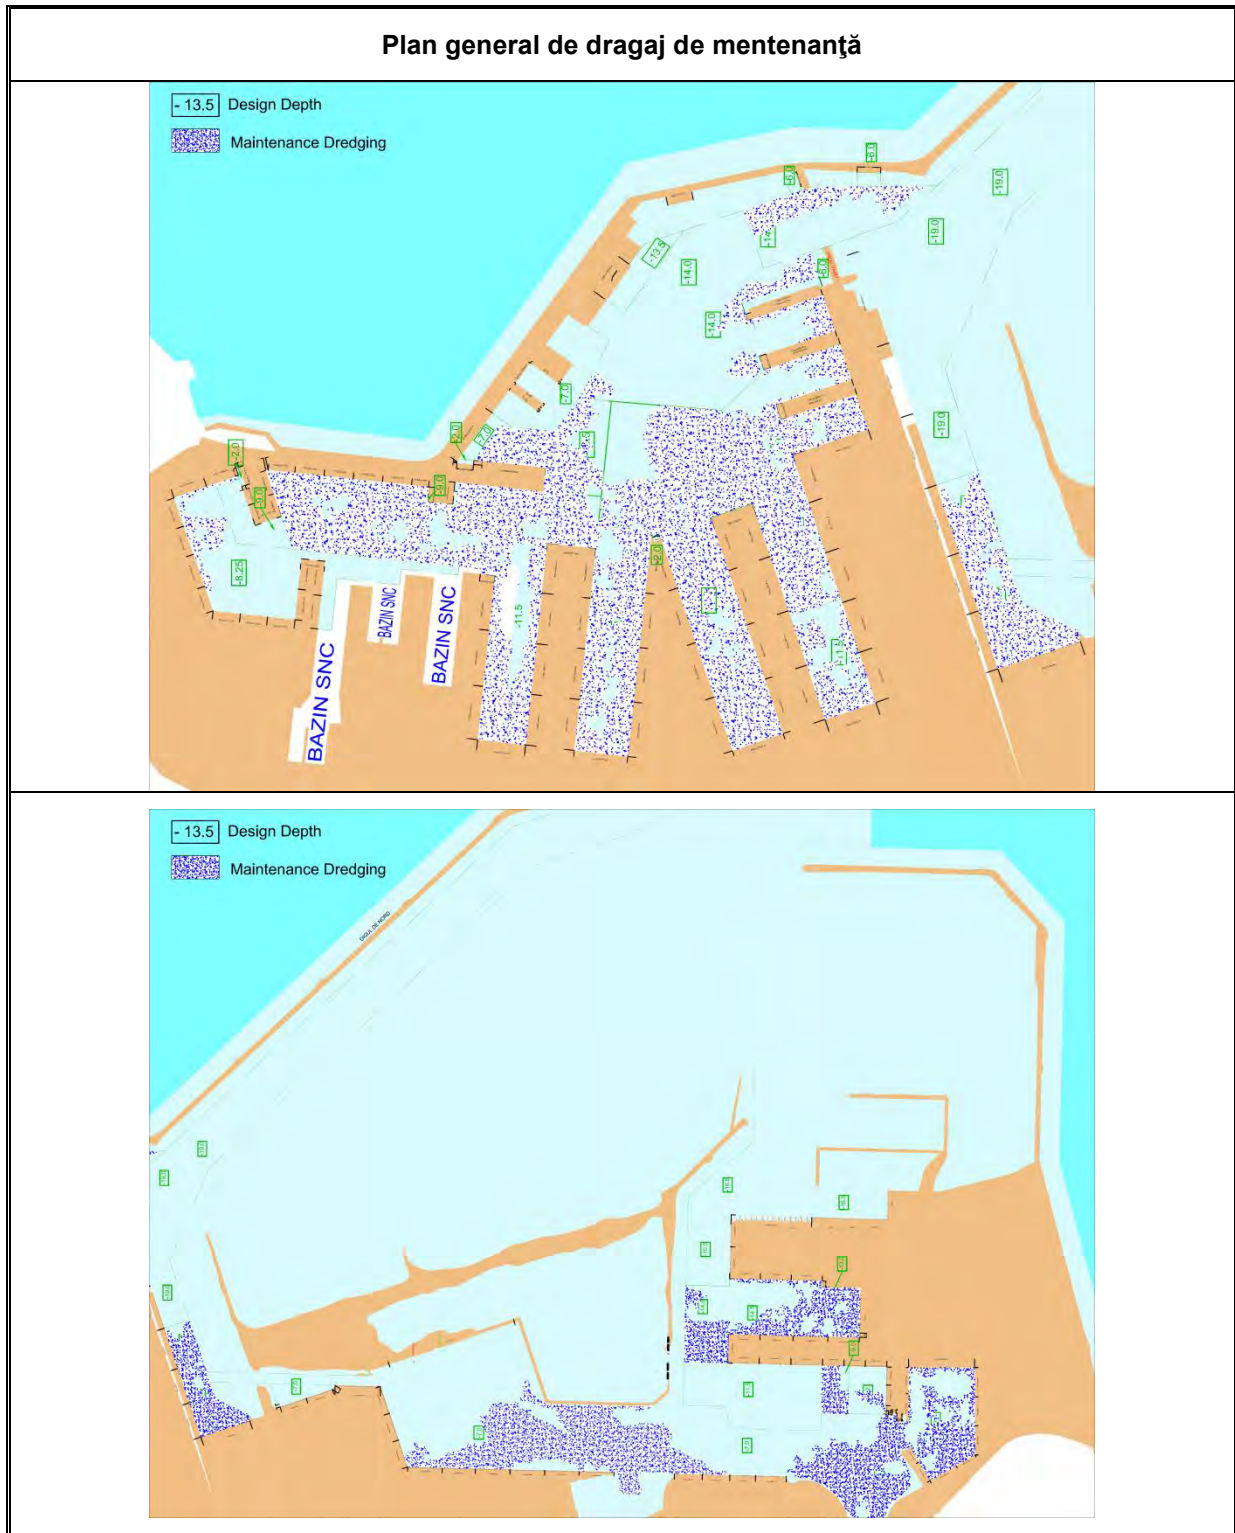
Plan de dragare de mentenanță portul Constanța.
